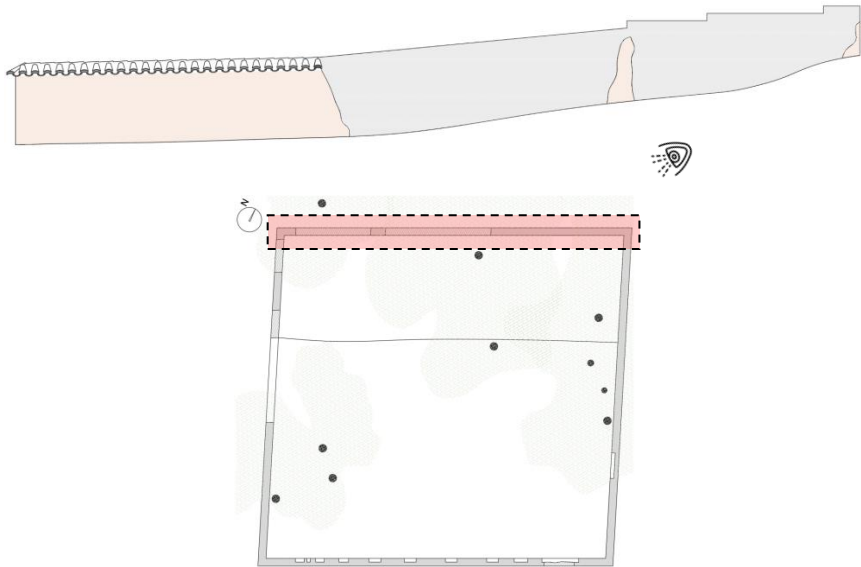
Esquema de planta-alzado fachada norte. Fuente propia.
